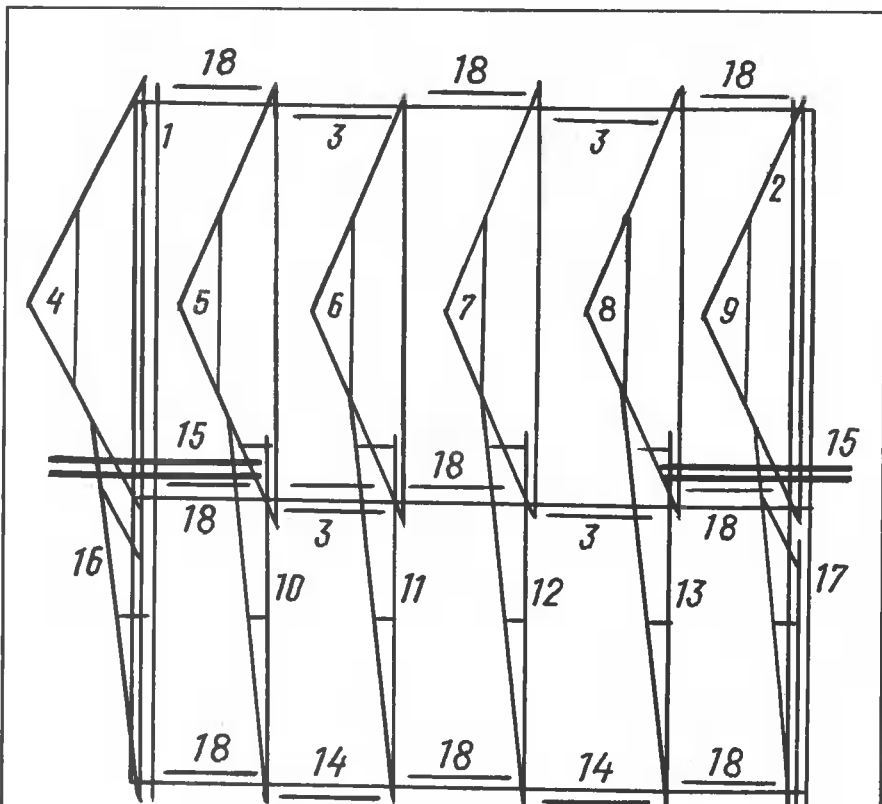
Порядок сборки каркаса крыши: 1,2 — бруски для крепления фронтонов, 3 — бруски для крепления ферм комнаты, 4...9 — фермы комнаты, 10...13 — фермы веранды, 14 — бруски для крепления ферм веранды, 15 — обрешетка для крепления карниза, 16,17 — фронтоны веранды, 18 — бруски между фермами.
